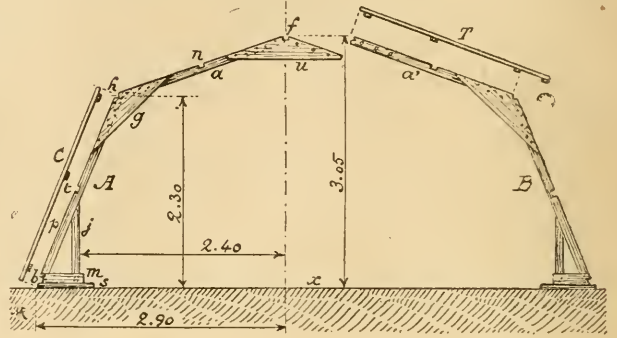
Coupe transversale d'un abri de Première urgence.
